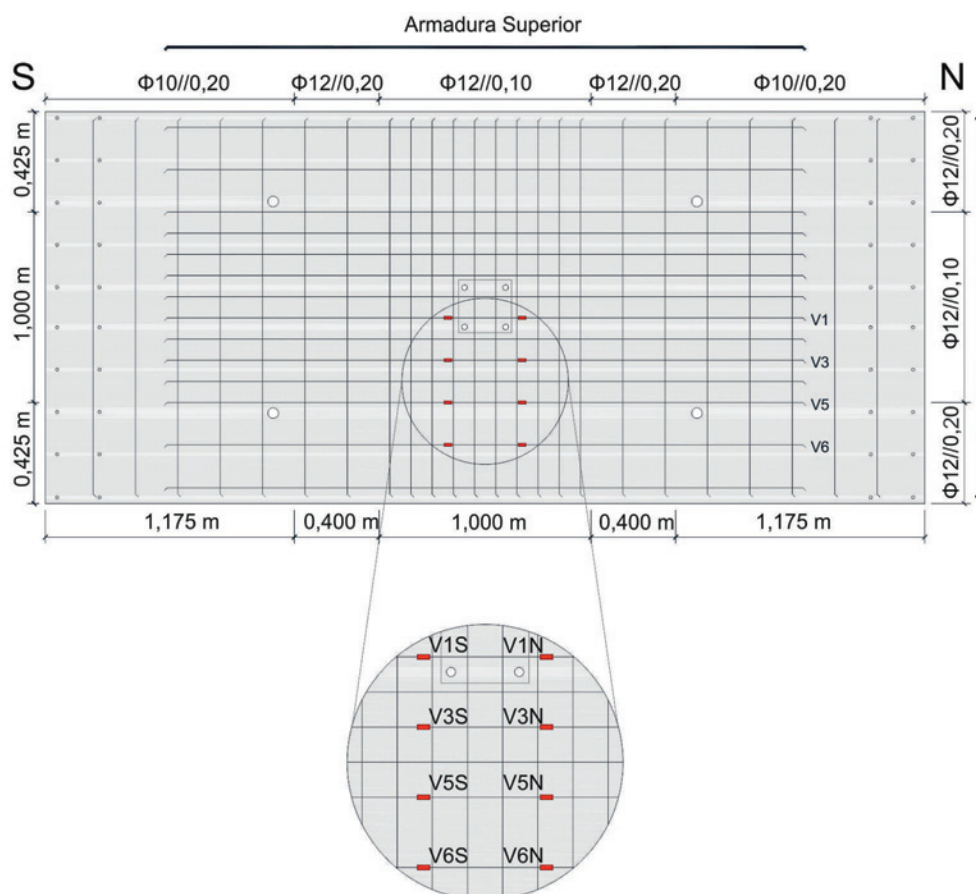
Pormenorização da armadura superior e respetiva localização de extensómetros em pormenor
